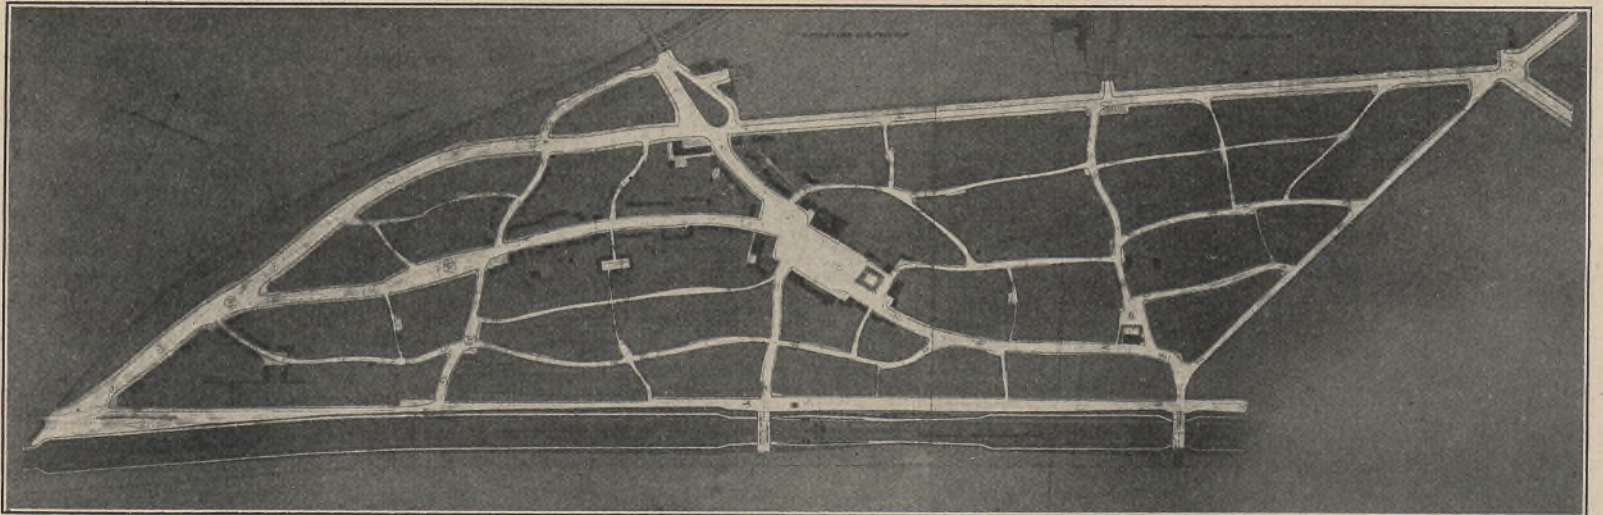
Lageplan der Gartenstadt zu Nürnberg. Architekt Prof. R. Riemerschmid, München.
